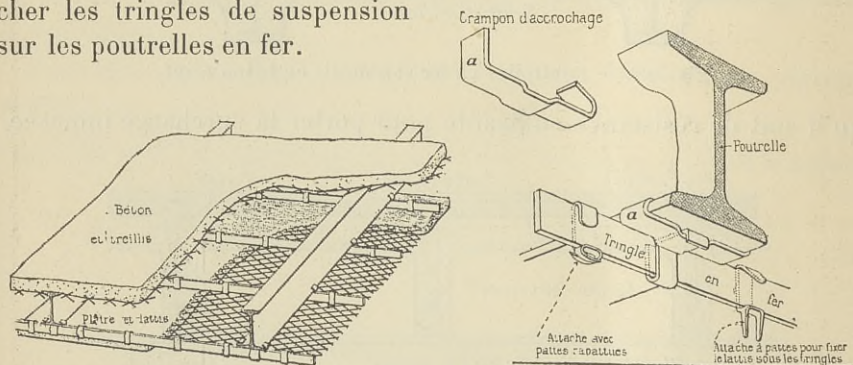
Poutrelles en fer, hourdis et dalle de plafonnage armés de métal déployé.
